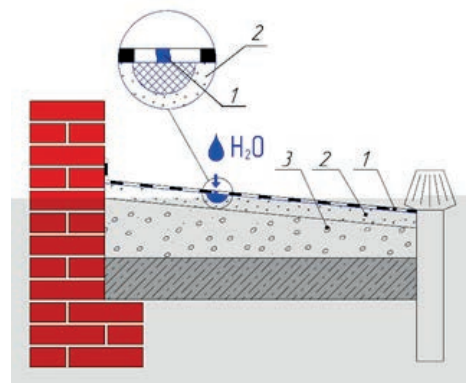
Протечка воды в пенобетонной кровле через гидроизоляцию локализуется в месте проникновения:
